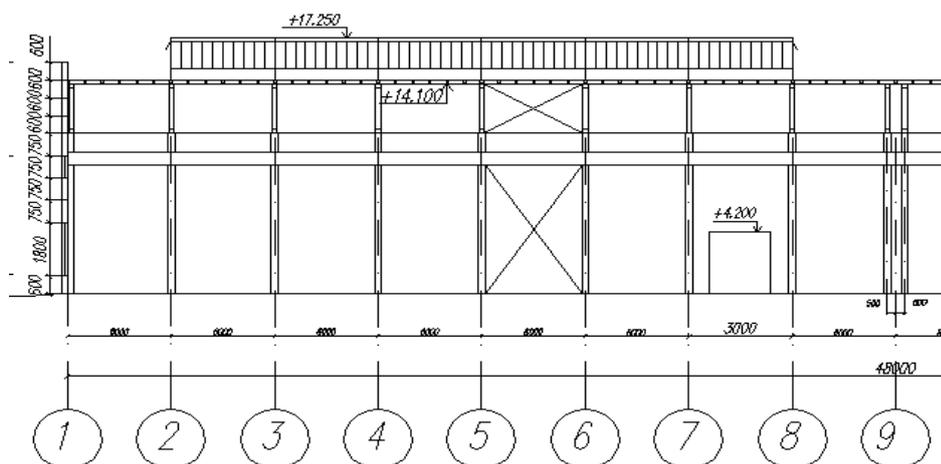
Продольный разрез промздания со связями по колоннам и стропильным конструкциям с привязкой торцевых колонн 0 мм.
